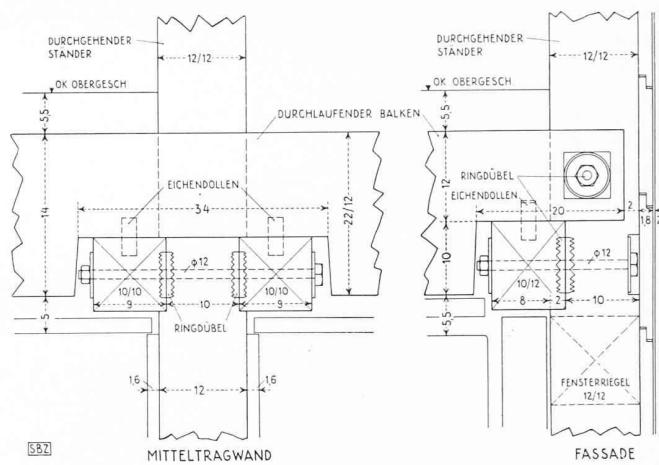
Anschluss der Balken an die durchgehenden Ständer; Detail 1 : 10
